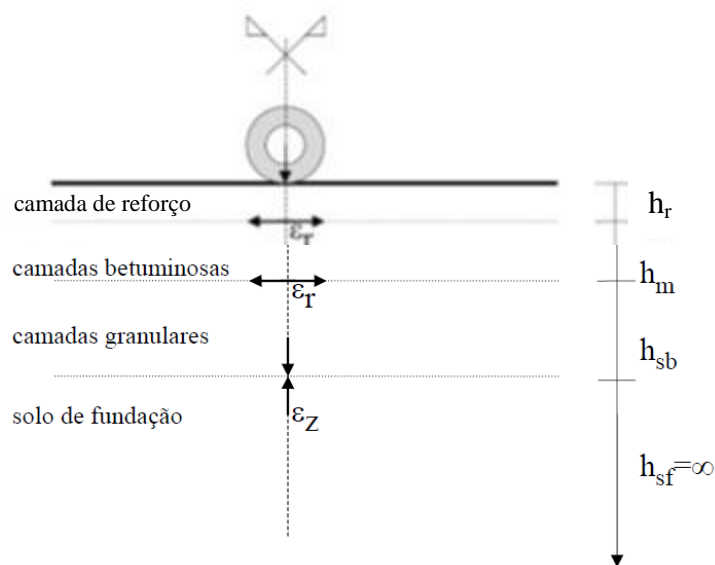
Extensões a calcular durante a análise estrutural do pavimento
